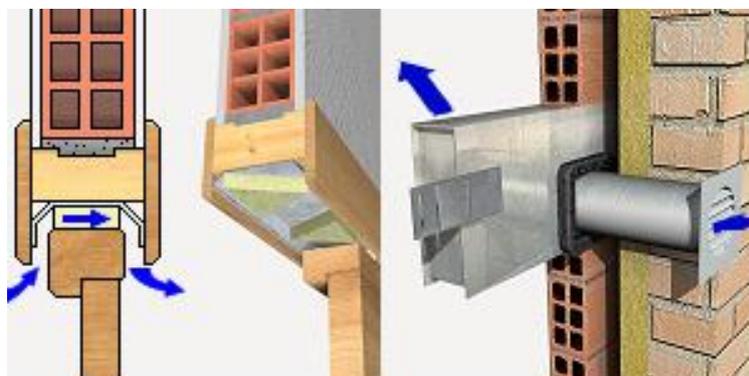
Vista detalle de encuentros con carpintería en REVIT
